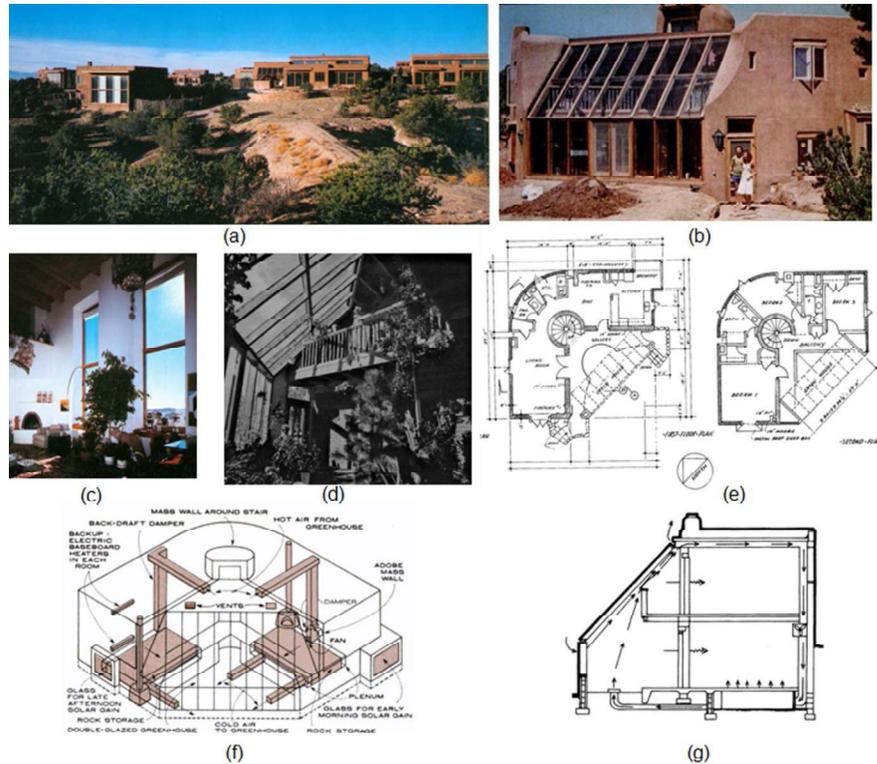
Susan y Wayne Nichols, *First Village*, Santa Fe, Nuevo México, E.U.A, (1973-1979): (a) Vista exterior general del conjunto, Casa tipo unit 1 (b) Vista exterior, (c), (d) Detalles interiores, (e) Plantas arquitectónicas, (f) Isometría de cómo funciona la energía solar pasiva en la casa, (g) Sección transversal.
